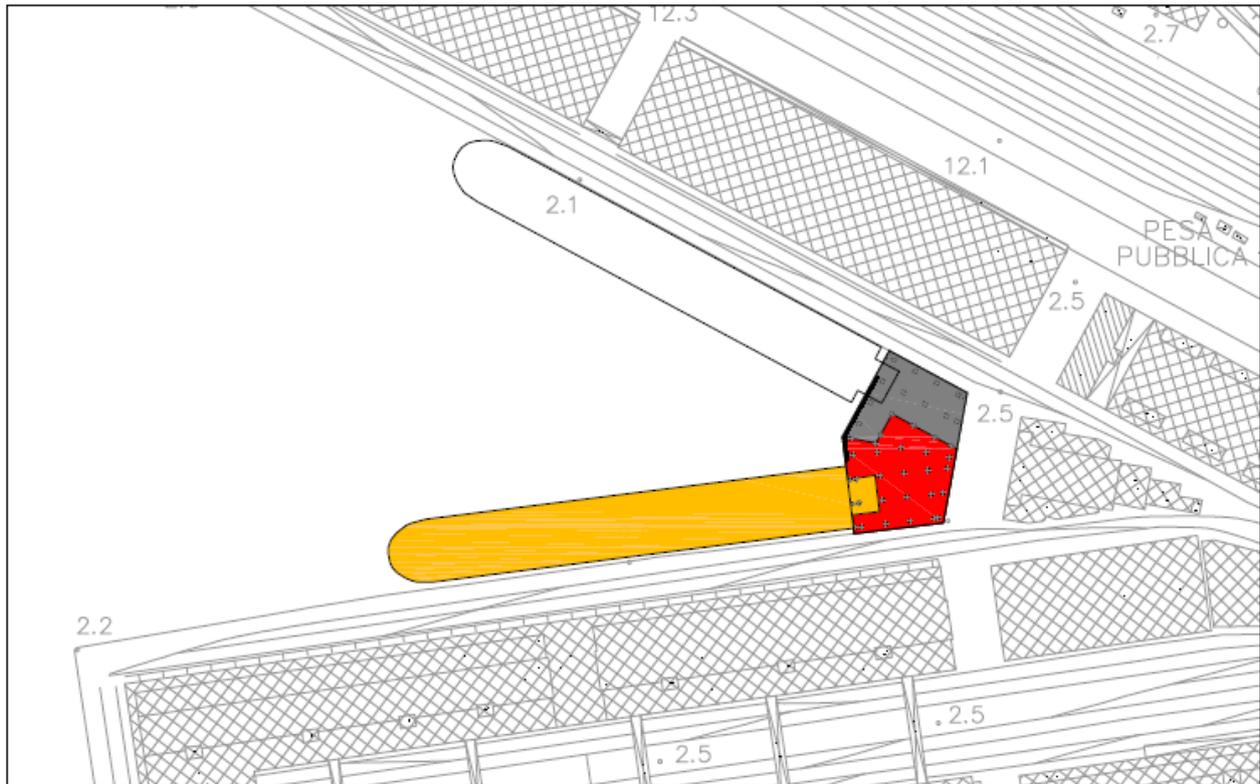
Fase 2: Completamento banchina con realizzazione secondo ormeggio (retino rosso)
